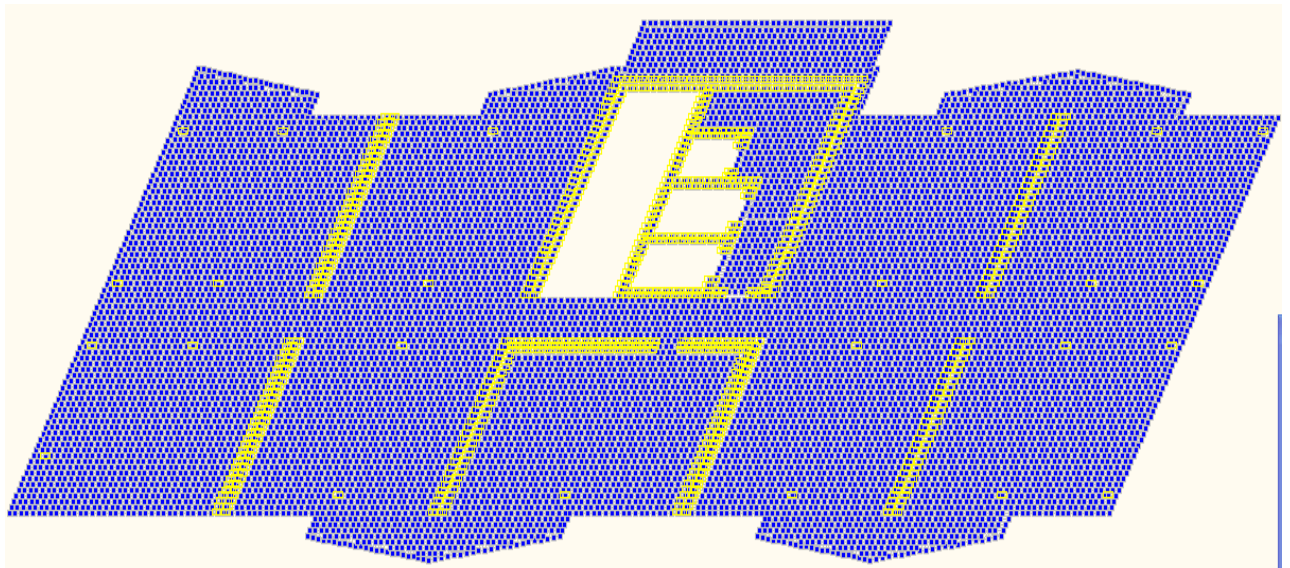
Расчетная схема монолитной плиты перекрытия
